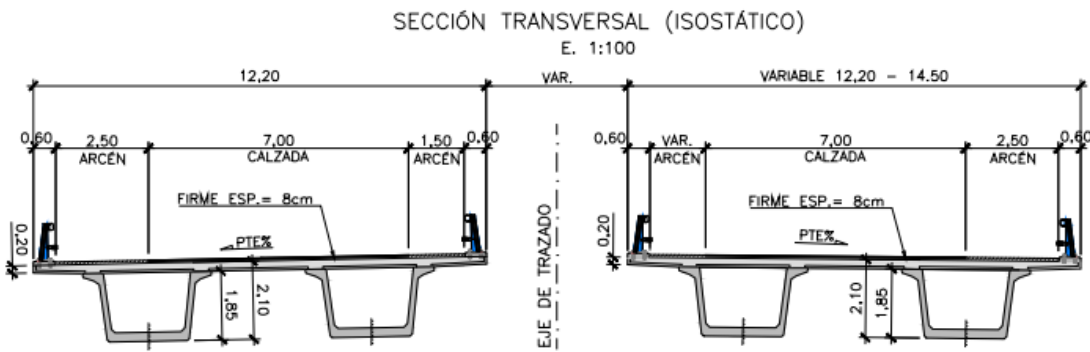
Sección tipo Viaducto de Beas (en vano 10)
